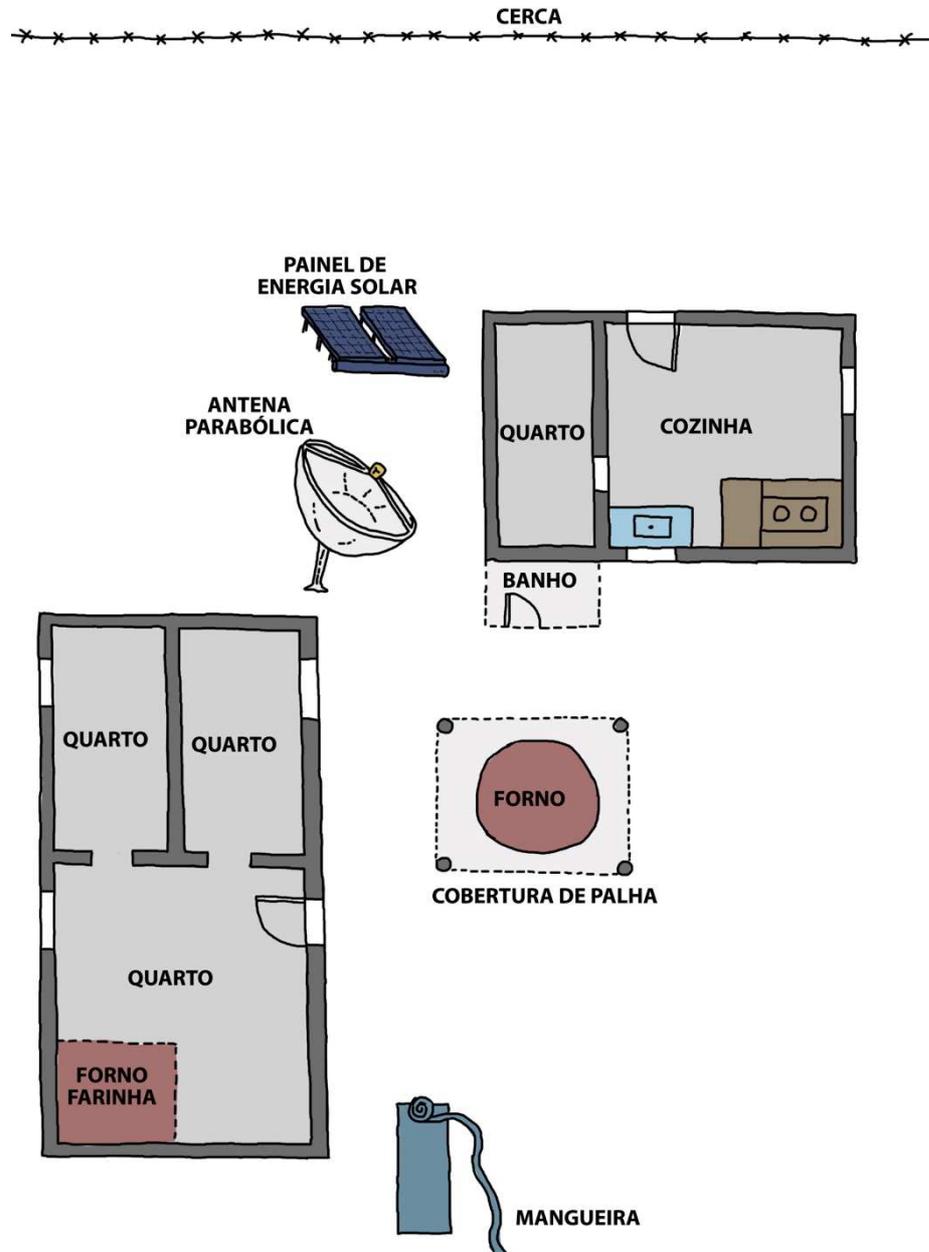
Planta baixa esquemática das construções no terreno de dona Dandara.
